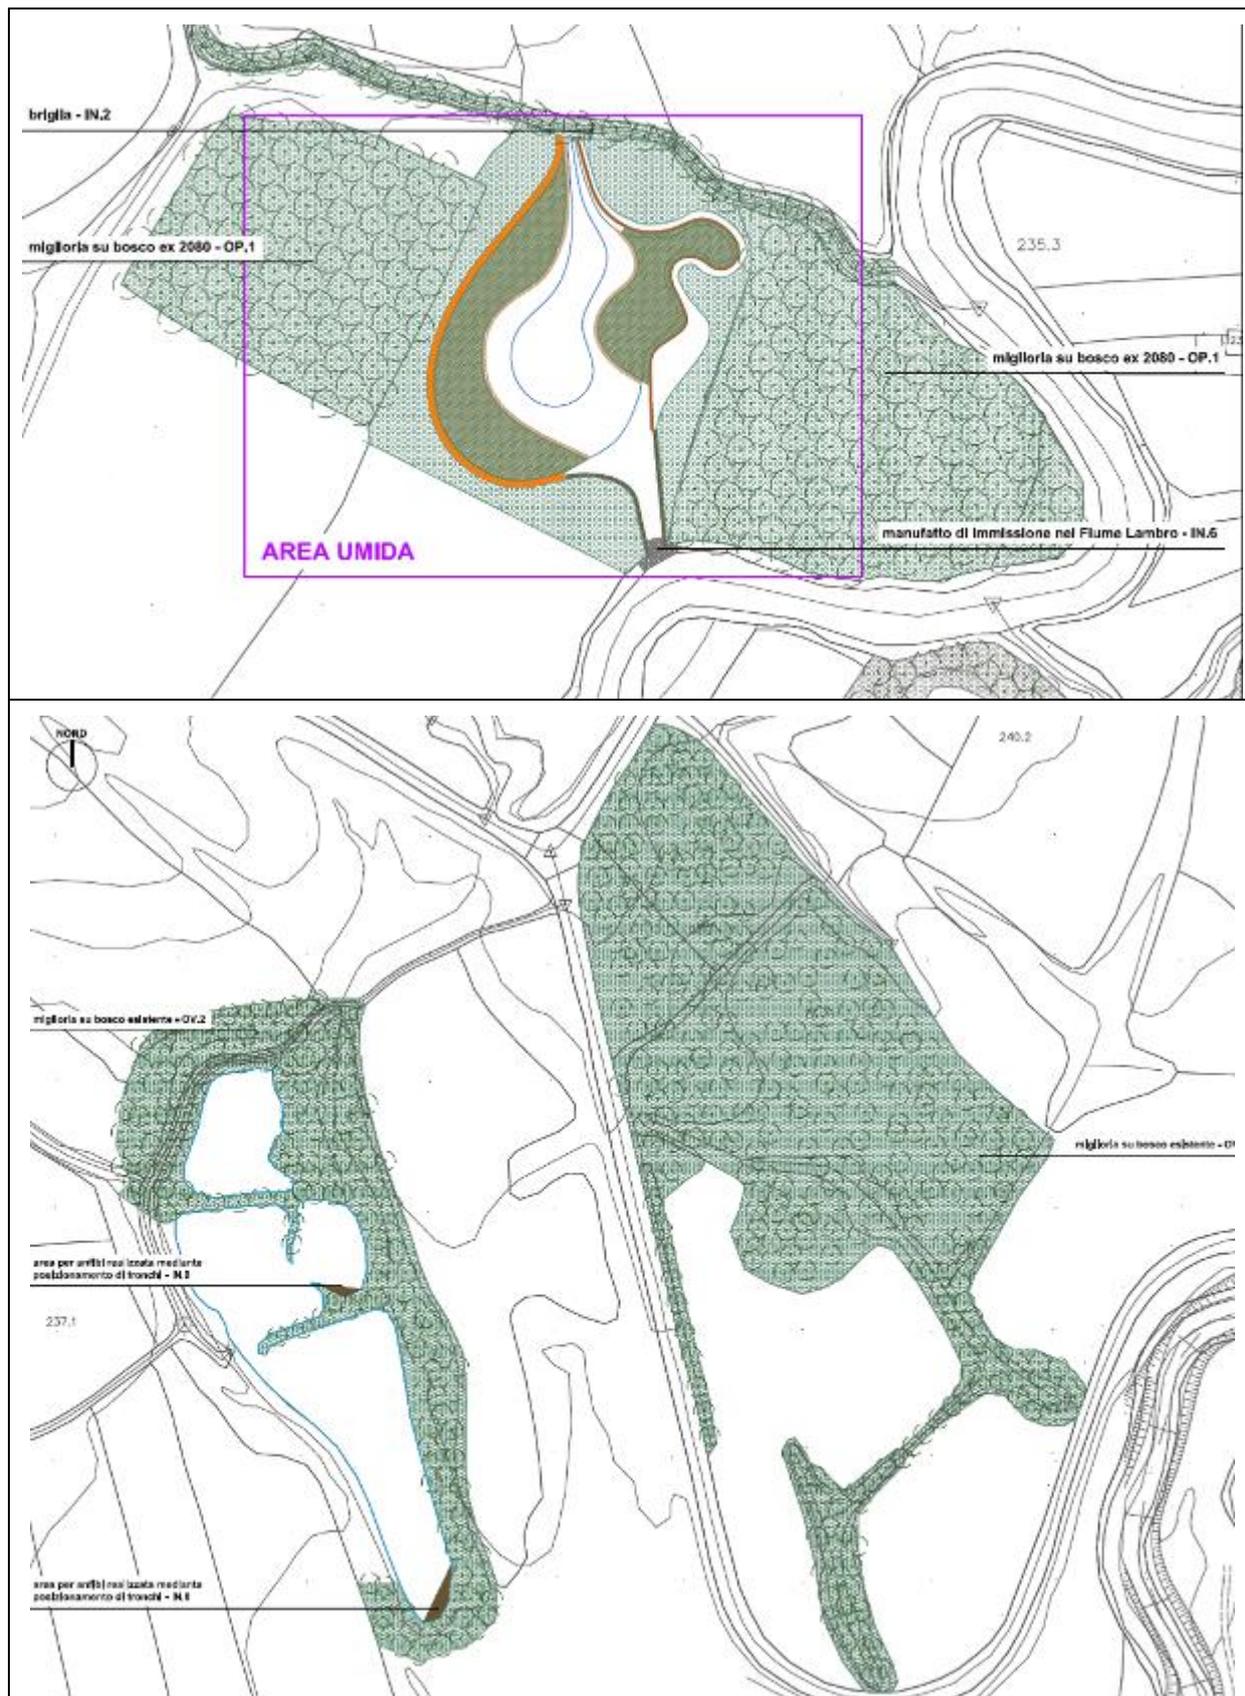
a) planimetria generale dell'intervento nell'area G, b) planimetria generale dell'intervento nell'area F
